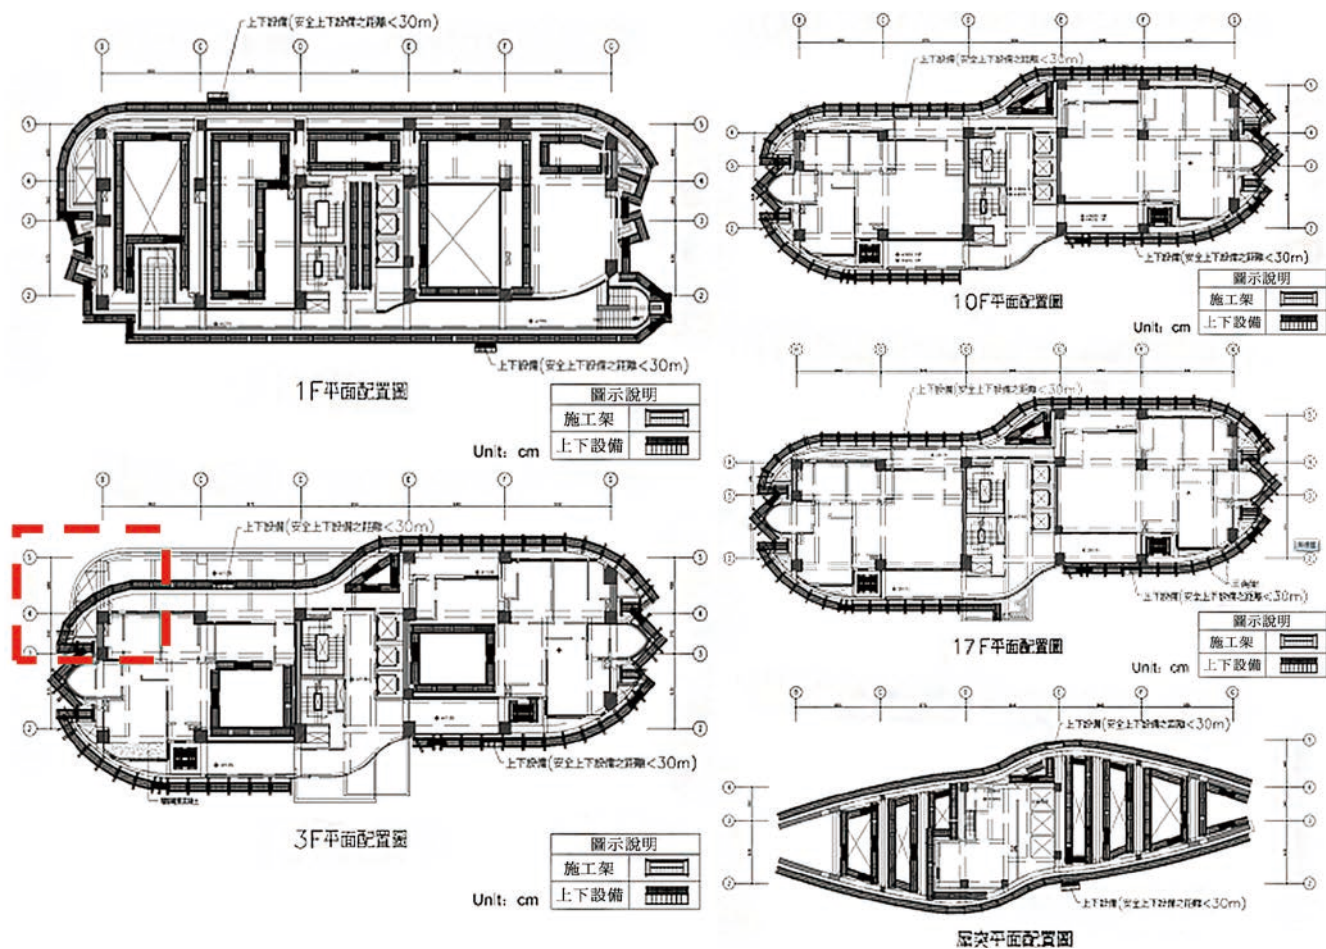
施工架施工圖因外牆造型變化，施工規劃錯誤的案例
